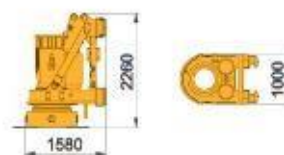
Vrtná souprava Bauer BG 18 H (19)
